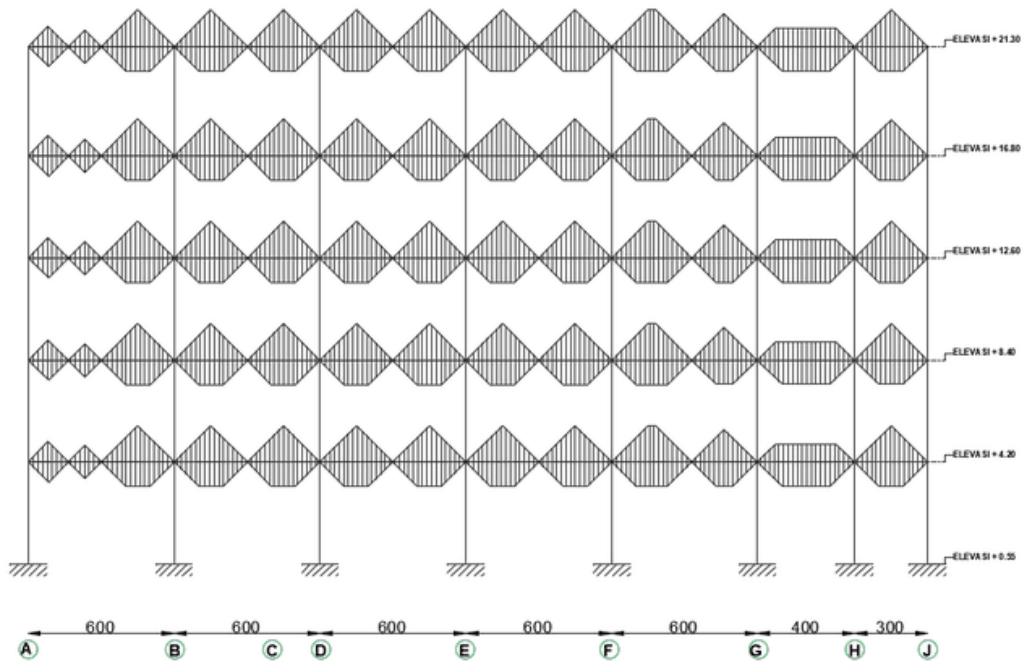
Denah Pembebanan Statik Ekuivalen
